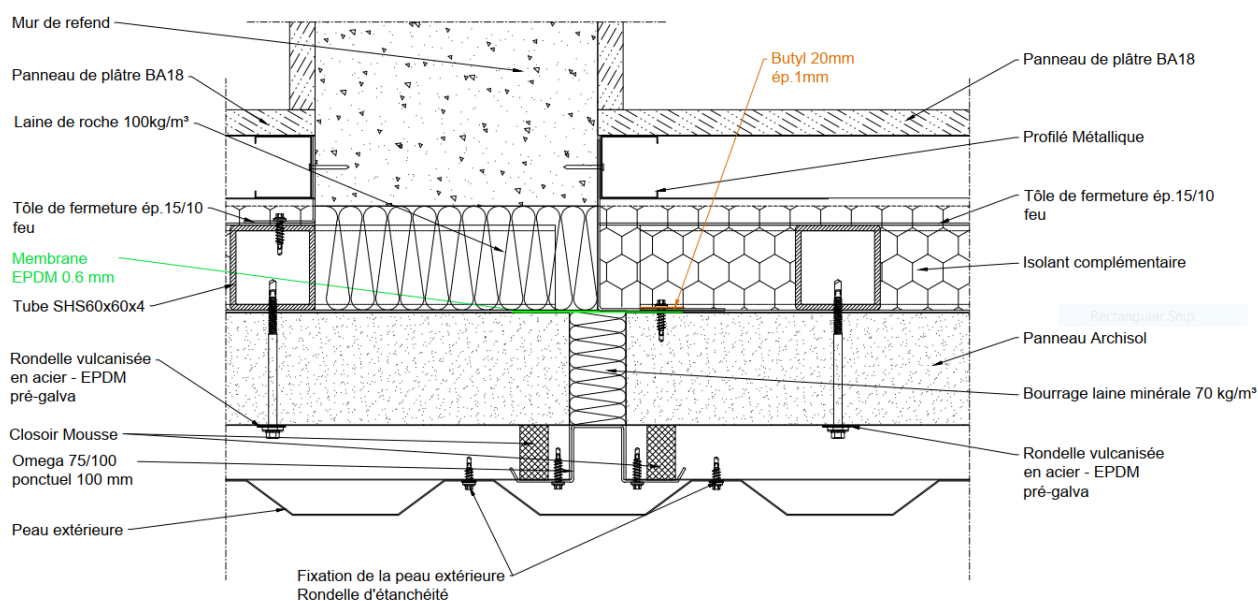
Coupe horizontale sur jonction verticale entre modules D2B - Archisol - Pose directe.
